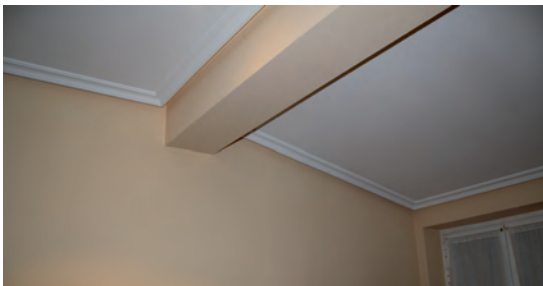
19. VIGA CUBIERTA EN VIVIENDA
